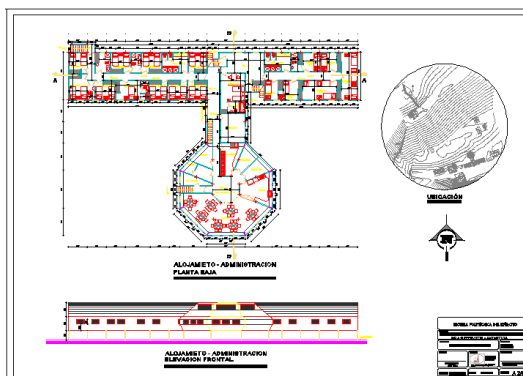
Captura del Plano Estructural Planta Baja Módulo Administrativo
